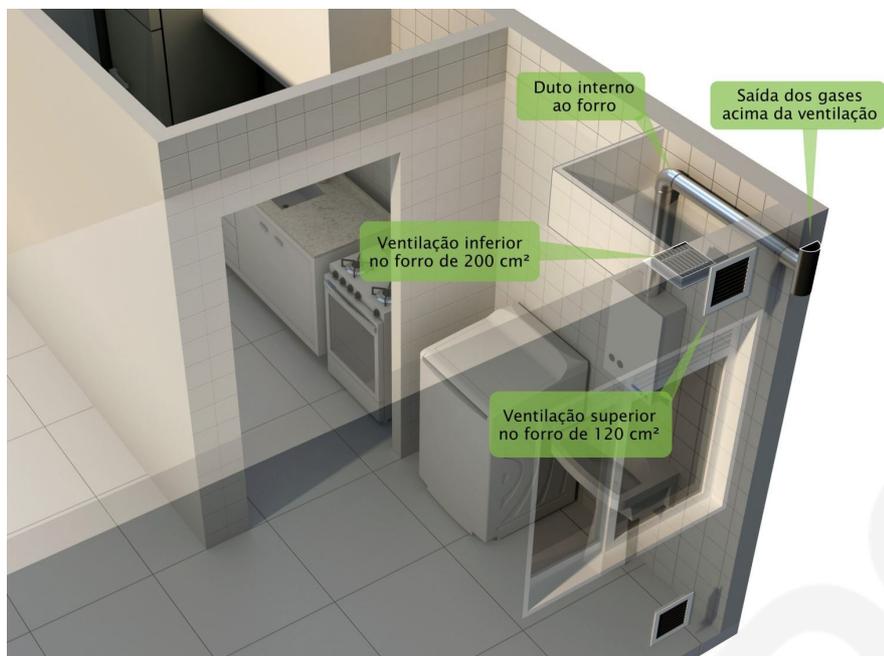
Instalação dos terminais de chaminé na fachada.
